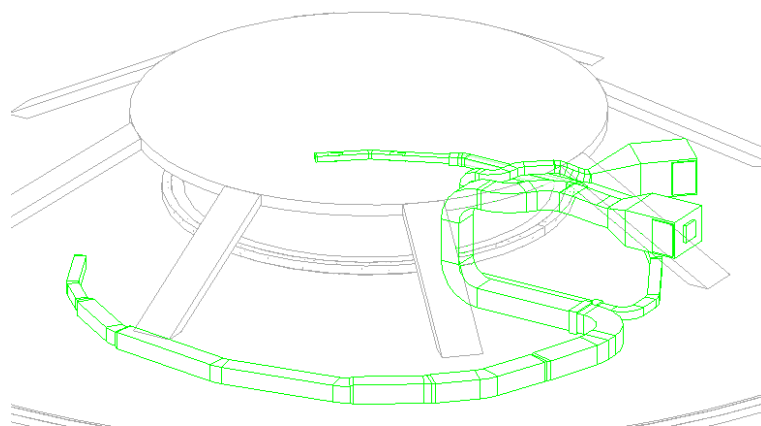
Conductos de extracción de aire del restaurante y los baños (Vista 3D)
